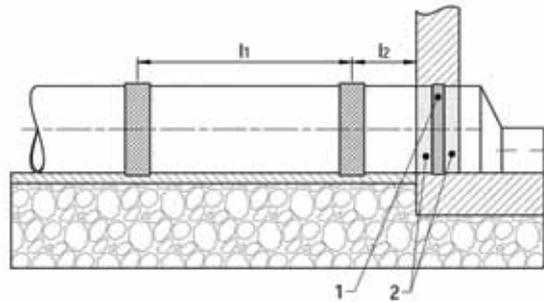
Anschluss an Bauwerke mit Bauwerkstützen / Mauerwerksdurchführungen
